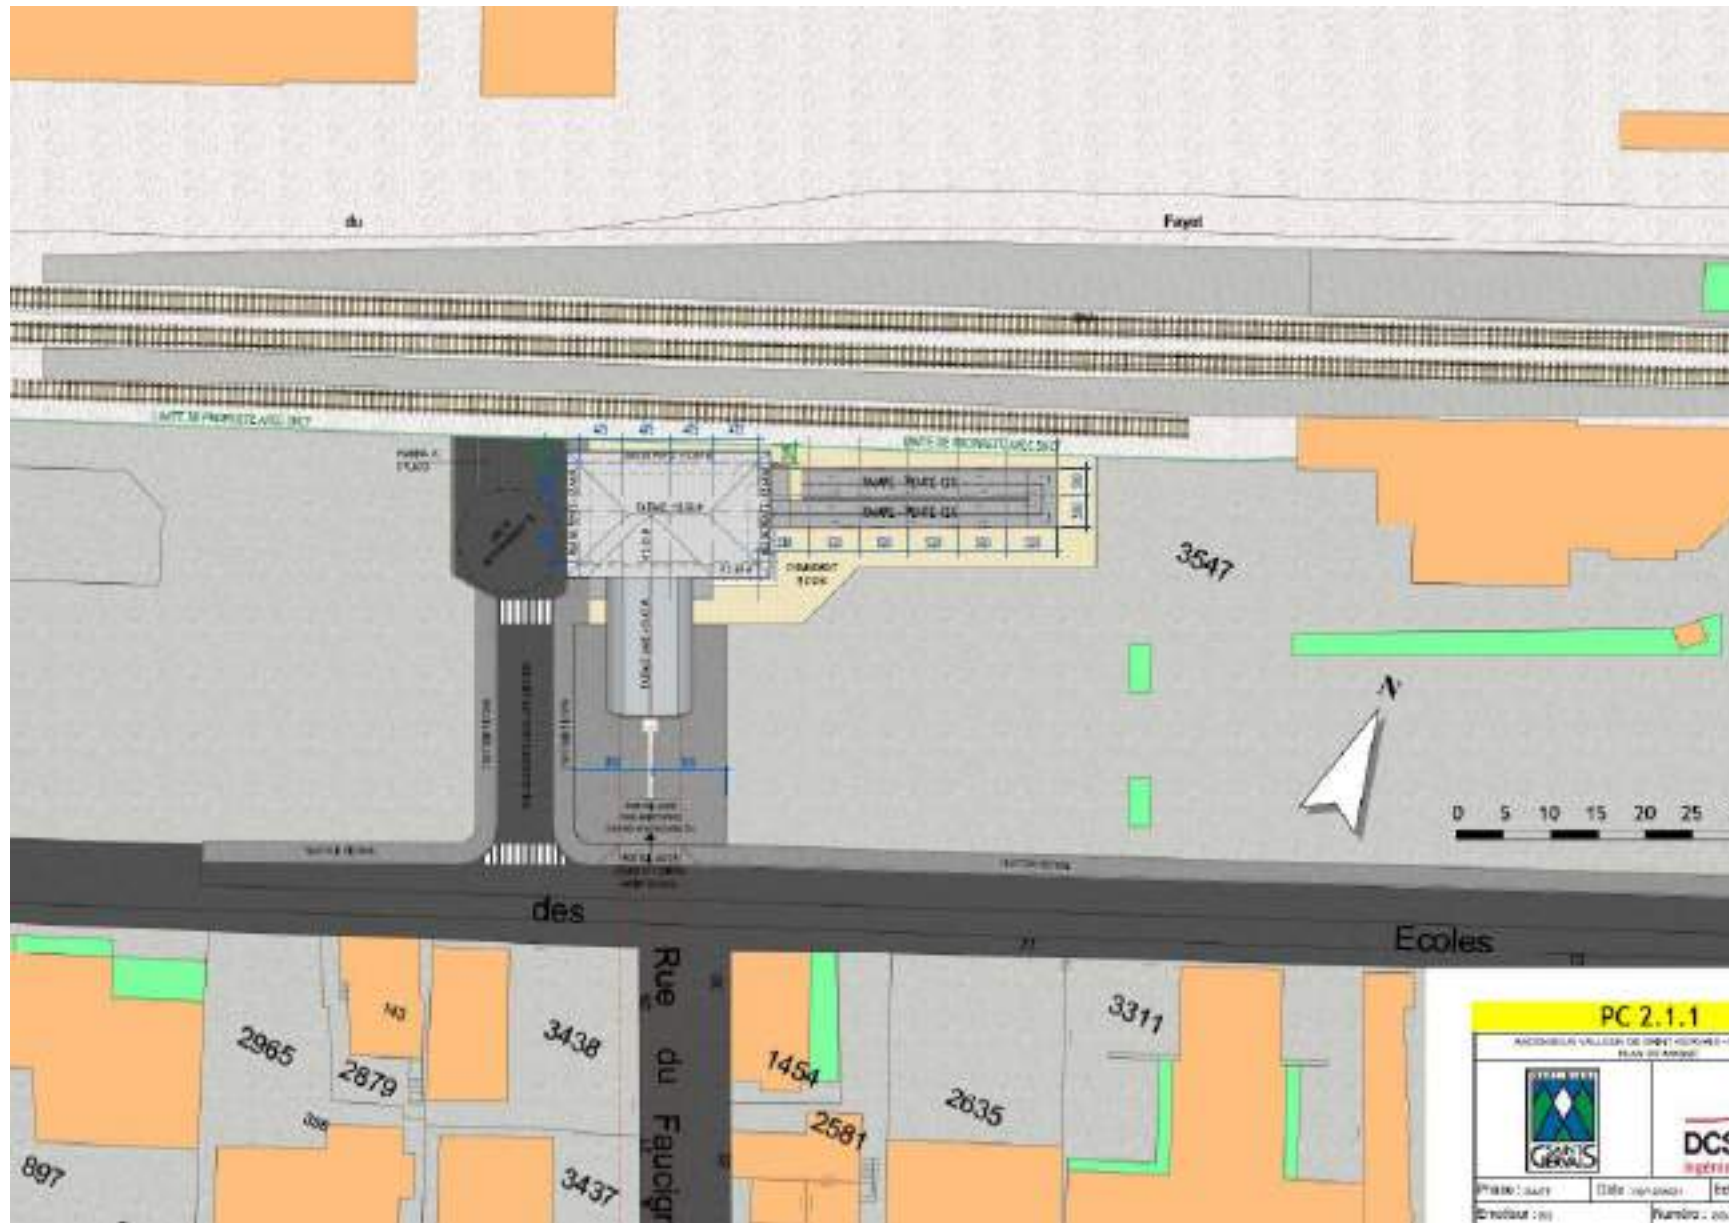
Plan masse de la gare aval (source : DCSA, PC)
